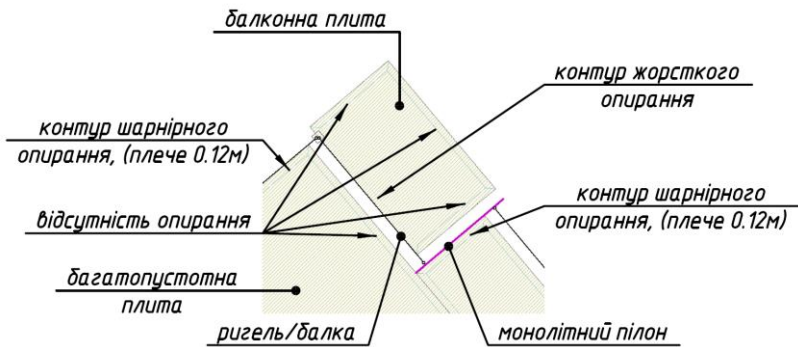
Фрагмент опирання плит перекриття на монолітні ригелі
